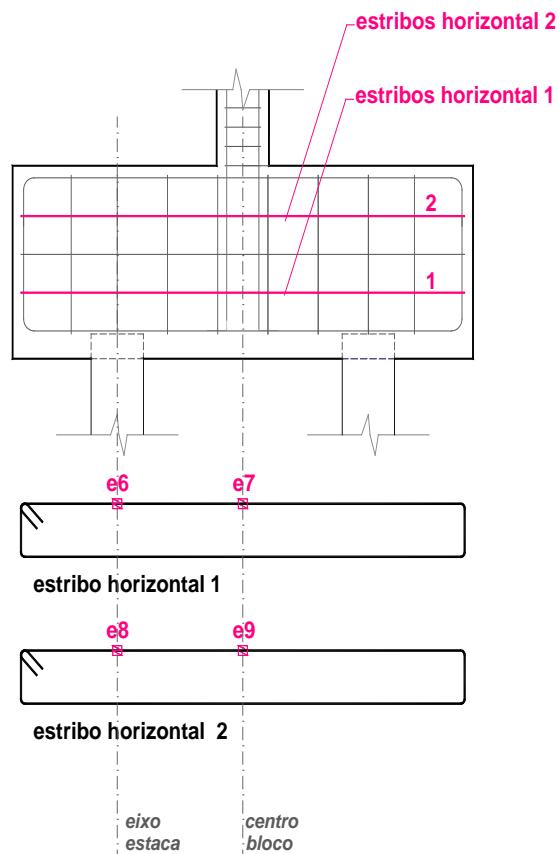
Posição dos extensômetro nos estribos horizontais
